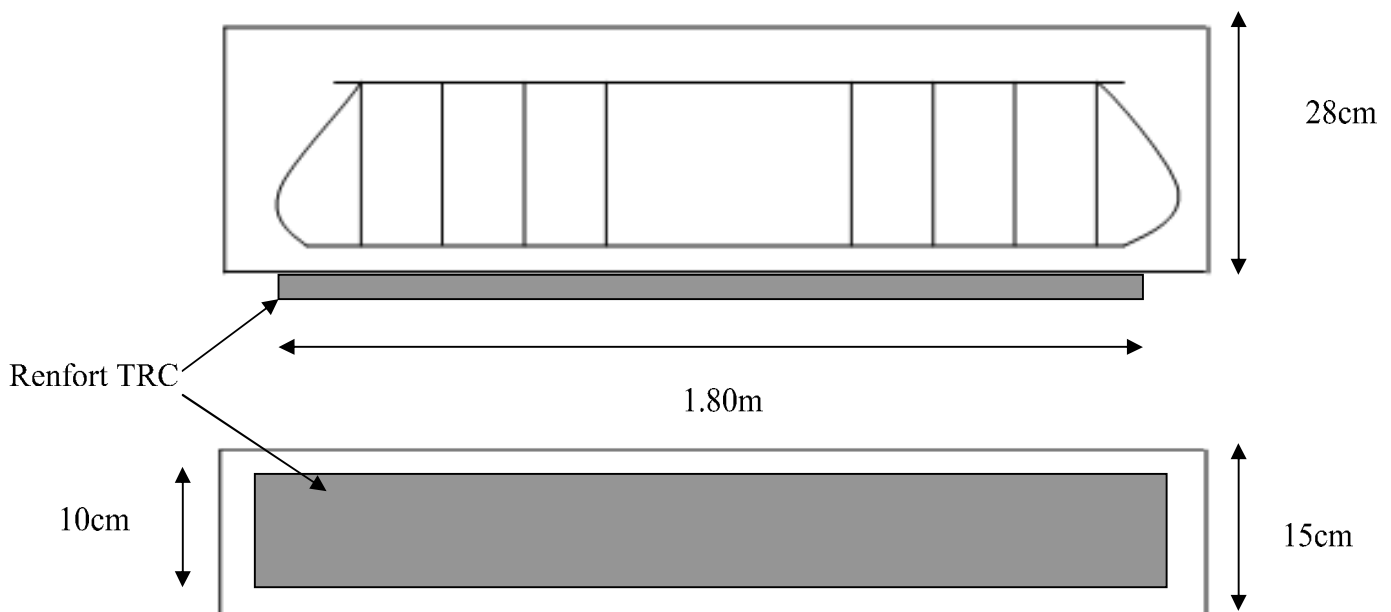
Renforcement d'une poutre à l'intrados par une plaque de TRC.
